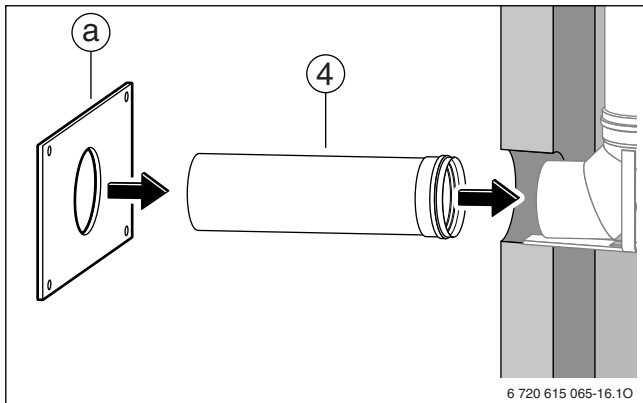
Montage der Sammelrohr-Verlängerung am Beispiel Schacht
